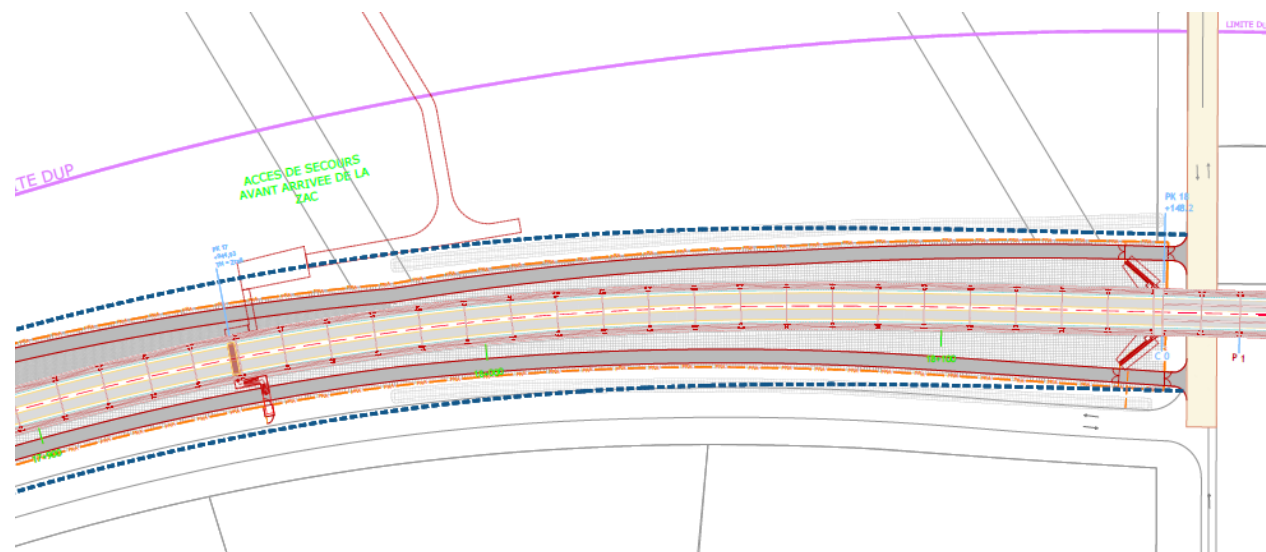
Vue en plan de la zone en remblai de Gonesse
